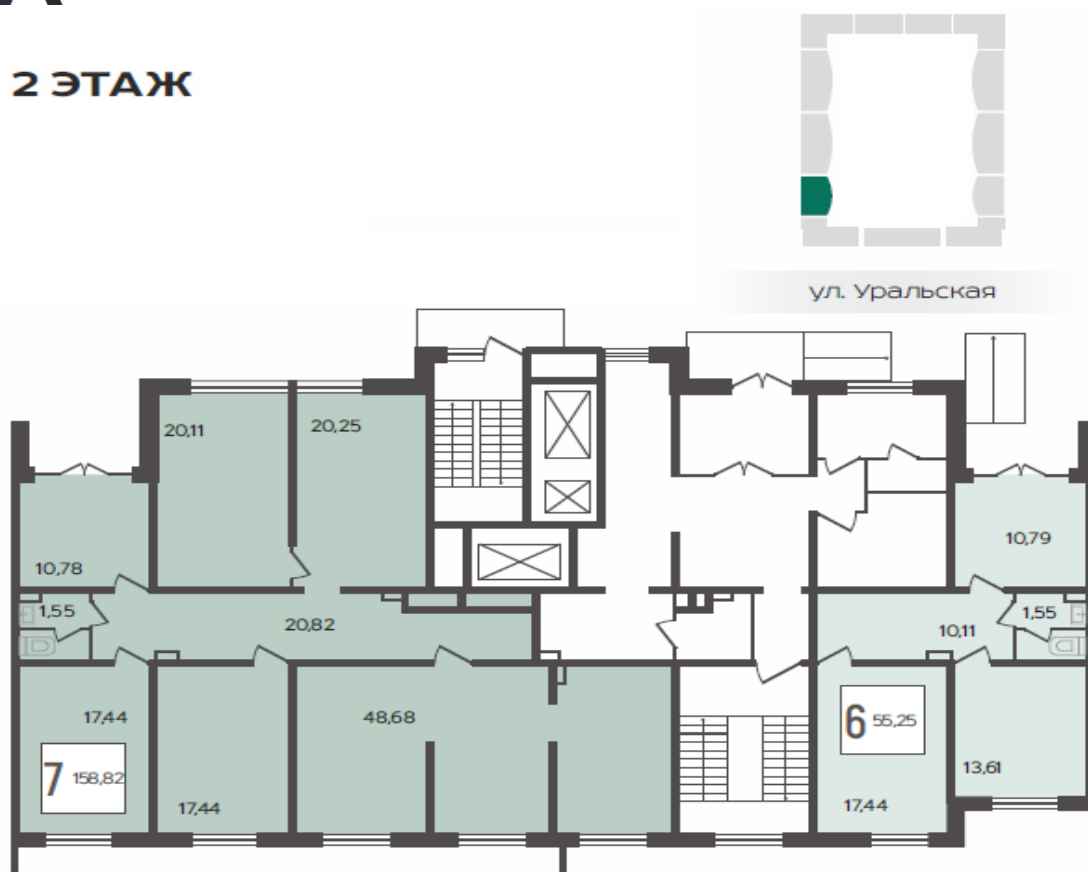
План коммерческих помещений 2 этажа БС-2 ЖК URAL
